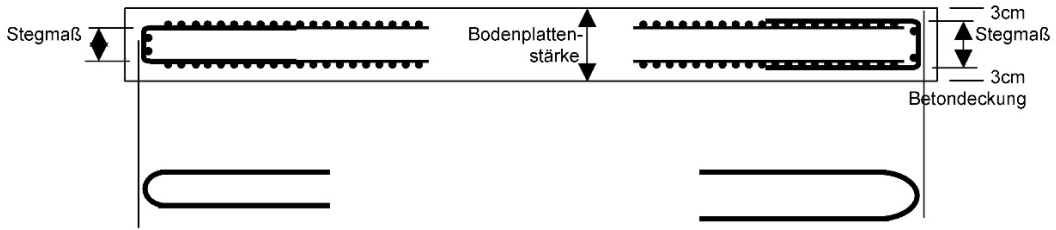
Einliegender (links) und umfassender (rechts) Steckbügel in seiner Zeichnungsform (oben) und in der wahren Biegeform (unten).
